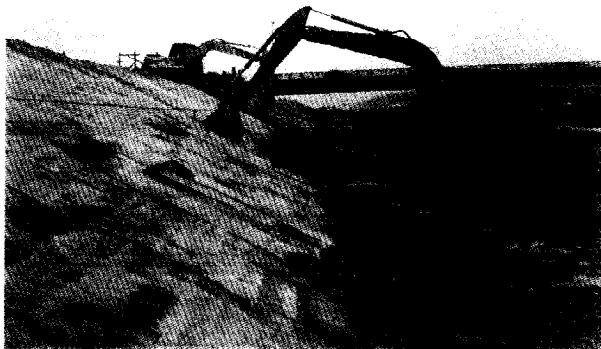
土羽バケットによるのり面の機械整形（中国地方建設局）
